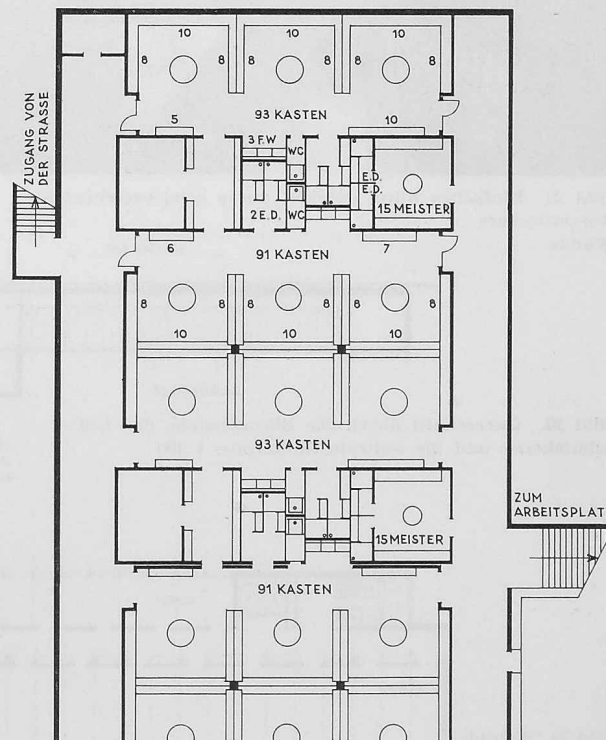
Grundrissausschnitt der Garderoben, 1:400
